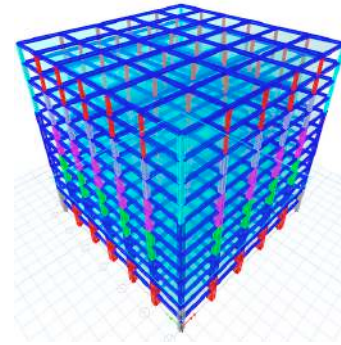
Esquema edificio de 12 niveles armado con losa maciza. Fuente: Autores
